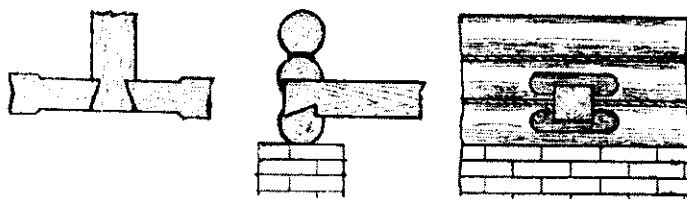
Врубка балок в деревянные рубленные стены, укладываемые на сплошном цоколе
